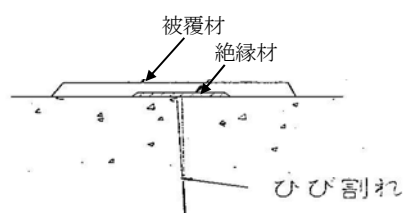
ひび割れ幅の変動がある場合
